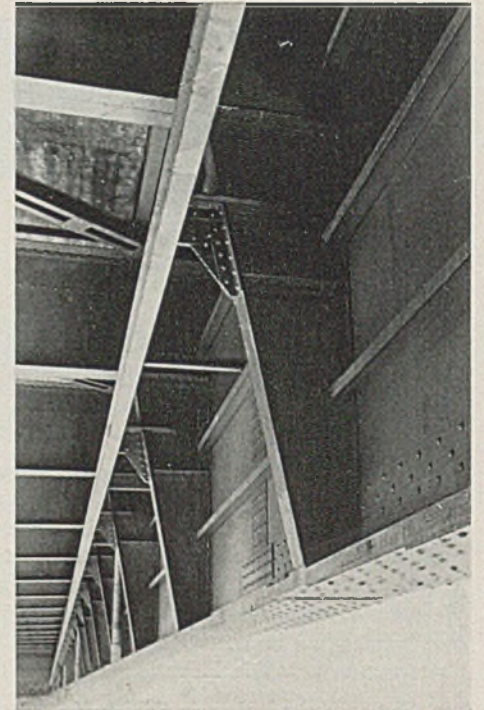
Befestigung der Laufträger für den Besichtigungswagen am Rahmenstiel des Querträgers.
